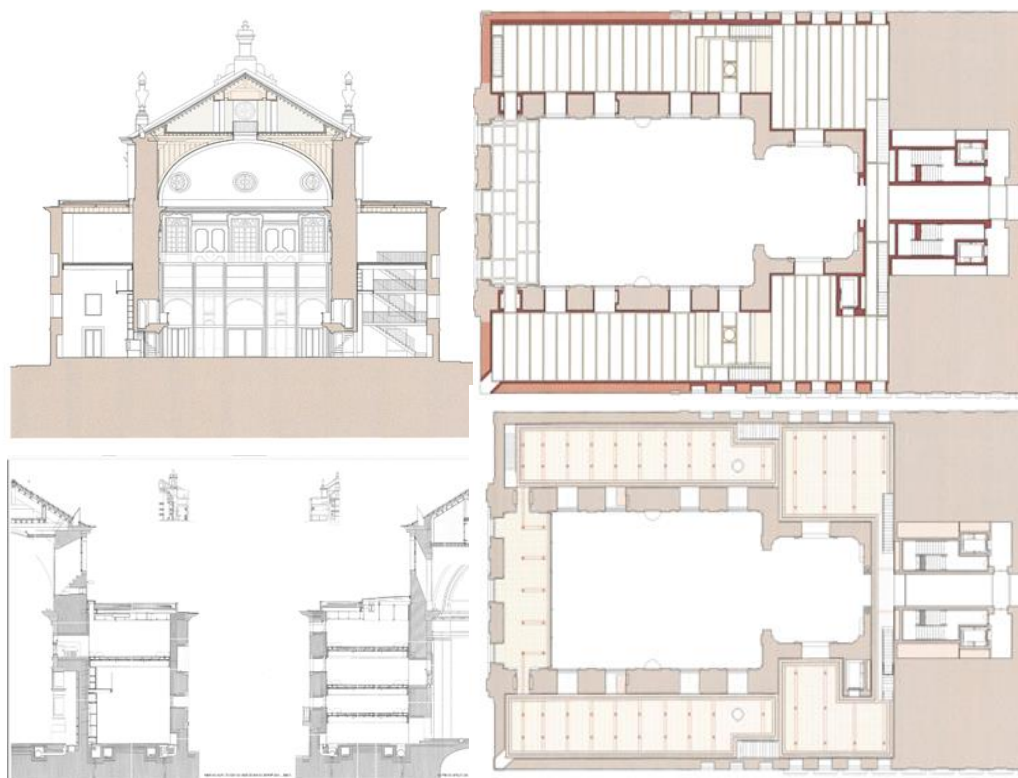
Plantas e cortes de arquitetura na zona da igreja (Byrne; Campos, 2008)
